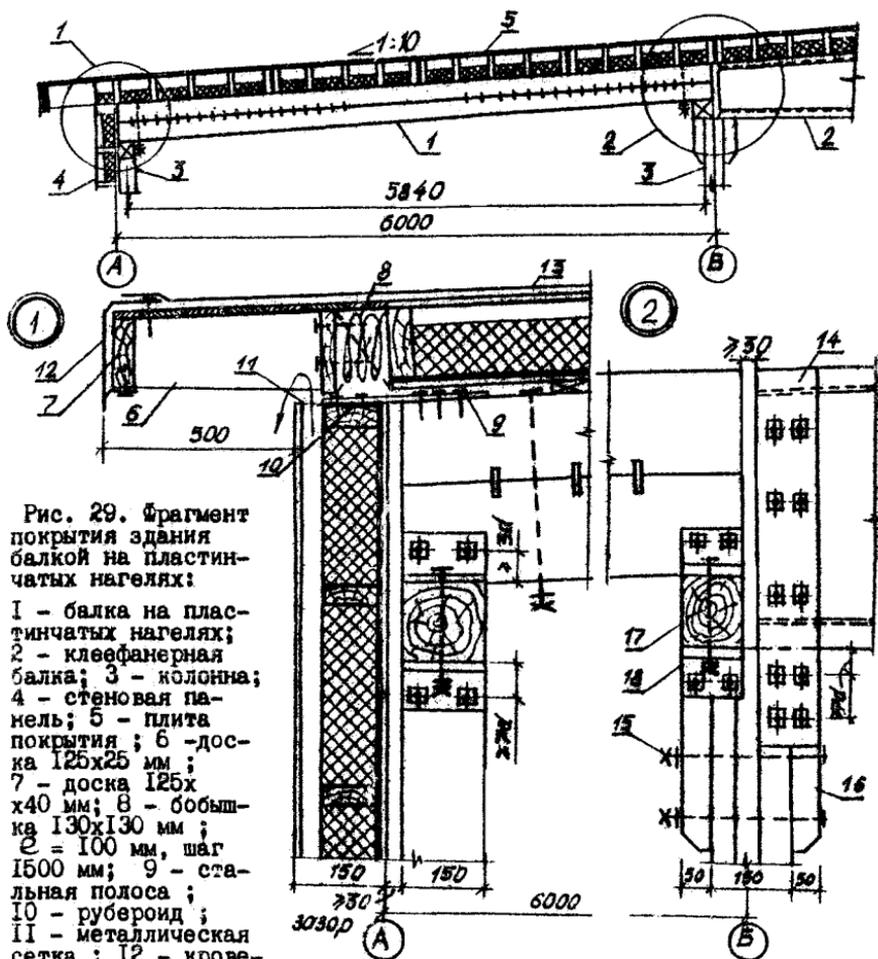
Фрагмент покрытия здания балкой на пластинчатых нагелях:
